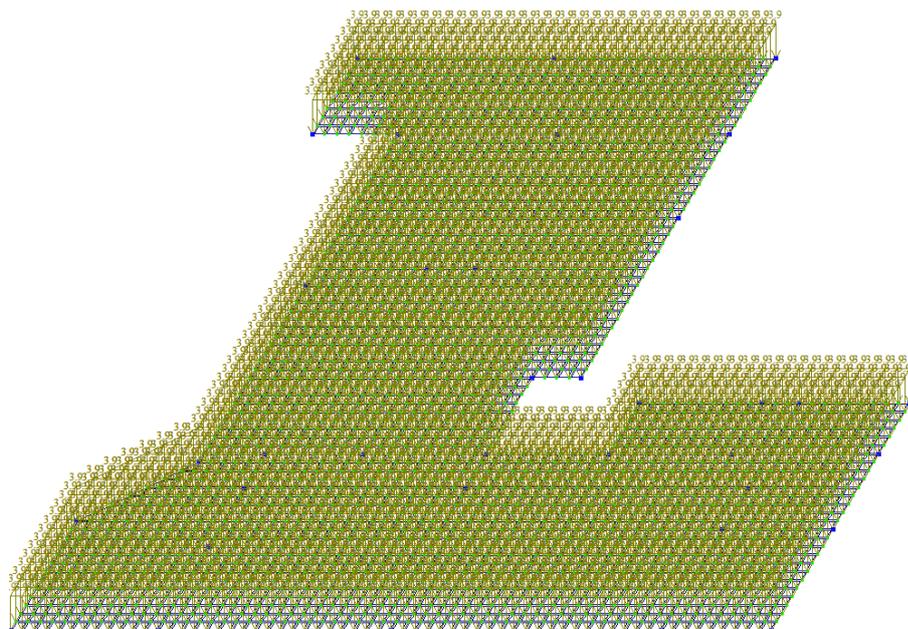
Расчетная схема монолитного железобетонного перекрытия
